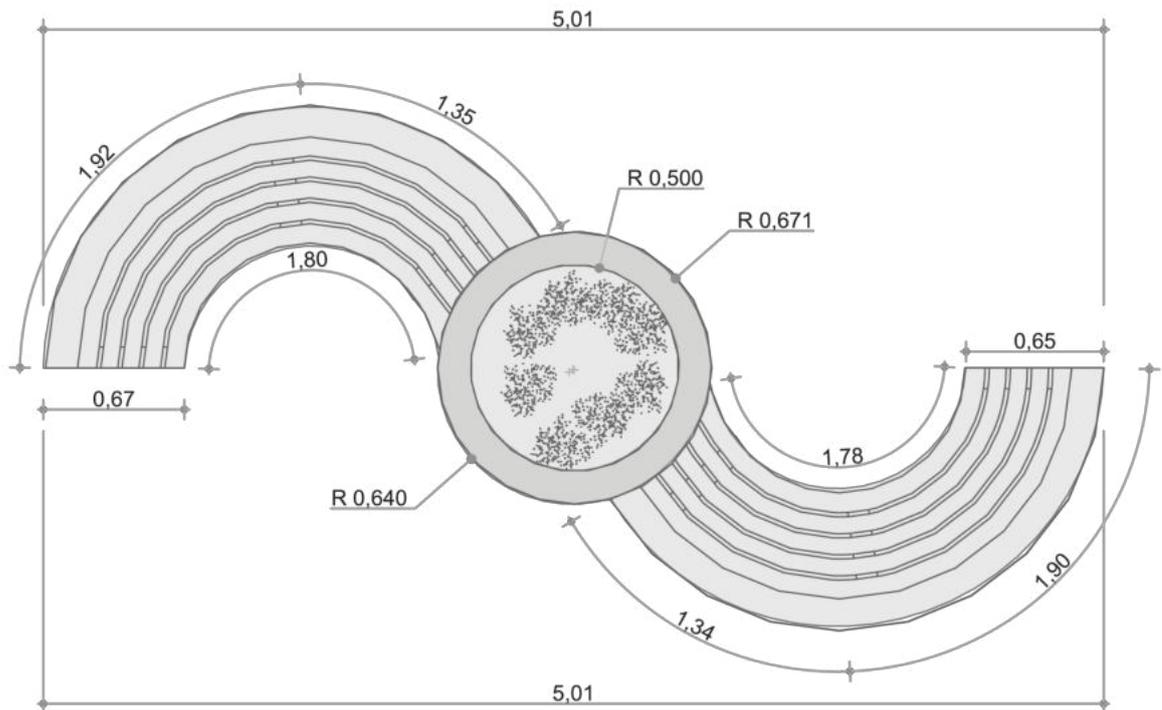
Planos 8 – Planta arquitectónica de Banca Tipo 2. Fuente: Elaboración propia
